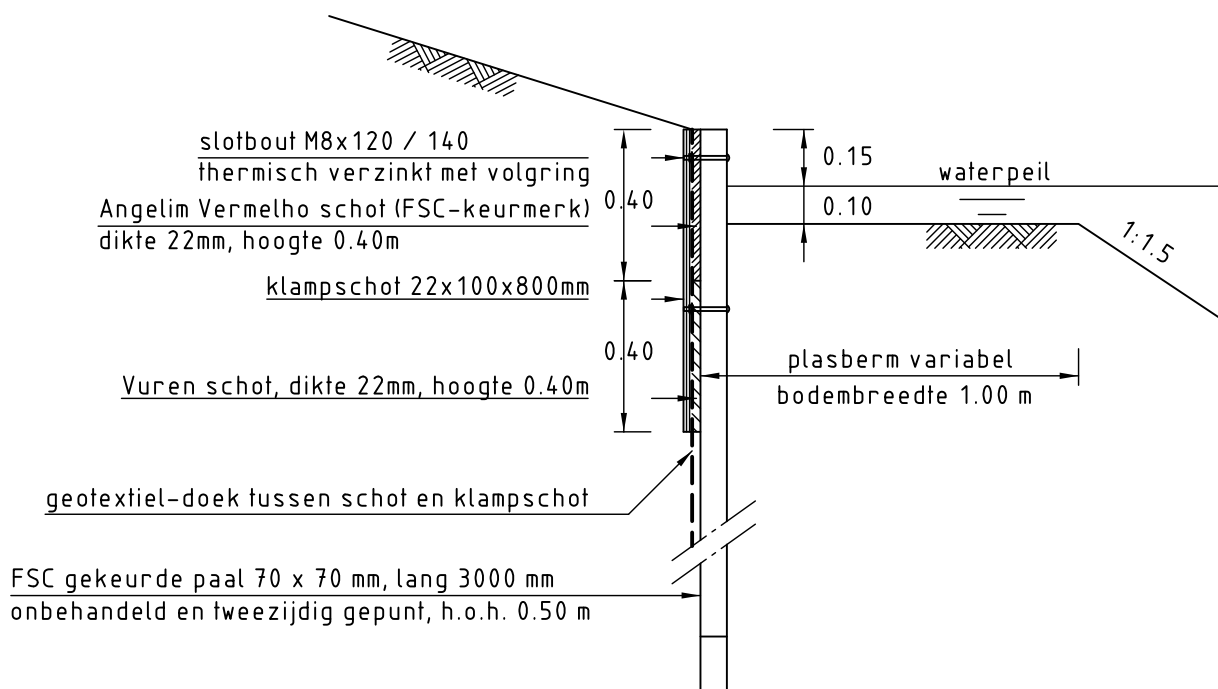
DETAIL BESCHOEIING HOOFDWATERGANG GRENZEND AAN UITGEGEVEN GEBIED
